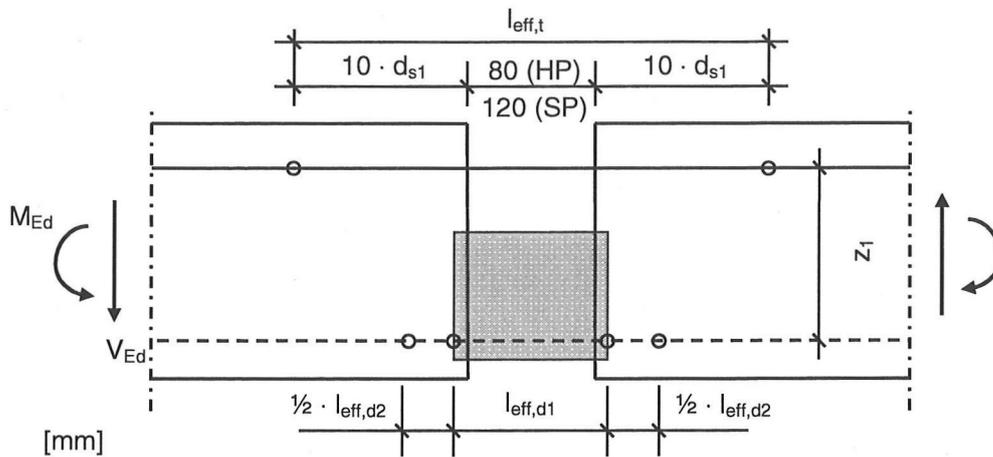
l_{eff} für Betonstahl BSt 500 NR
